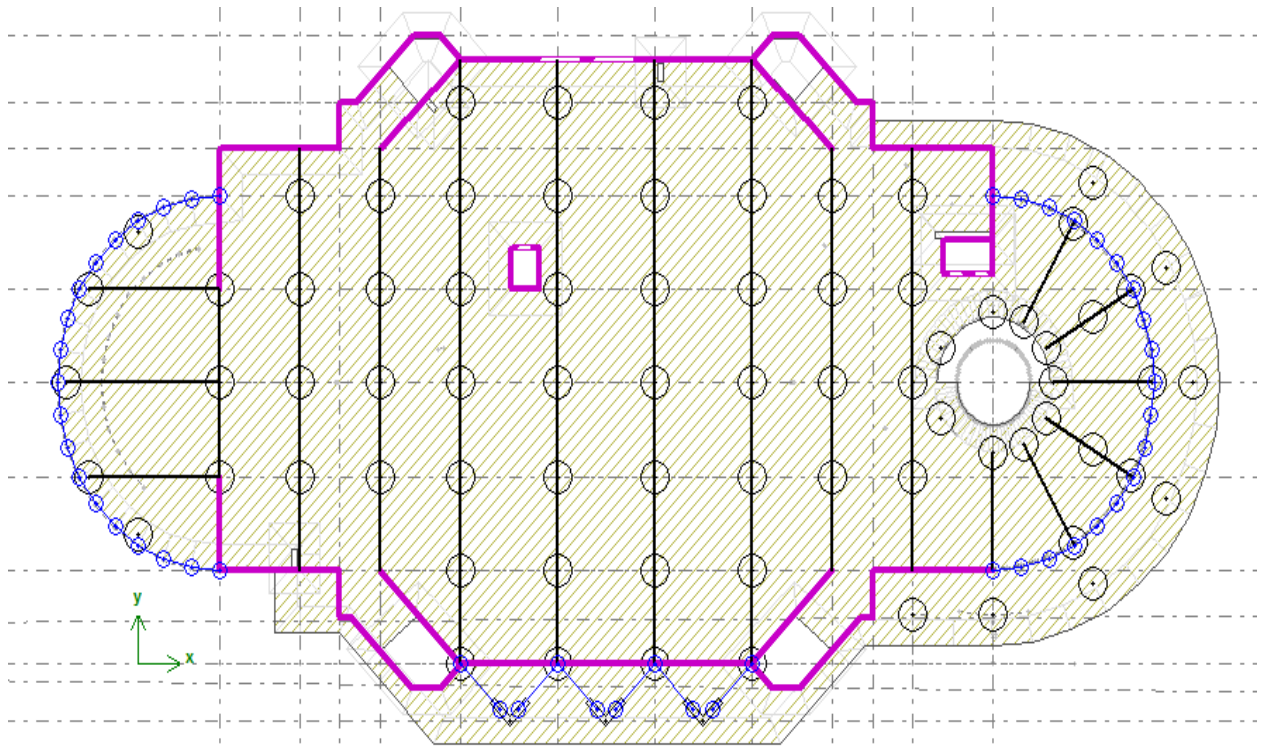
Розрахункова схема 1-го поверху будівлі
